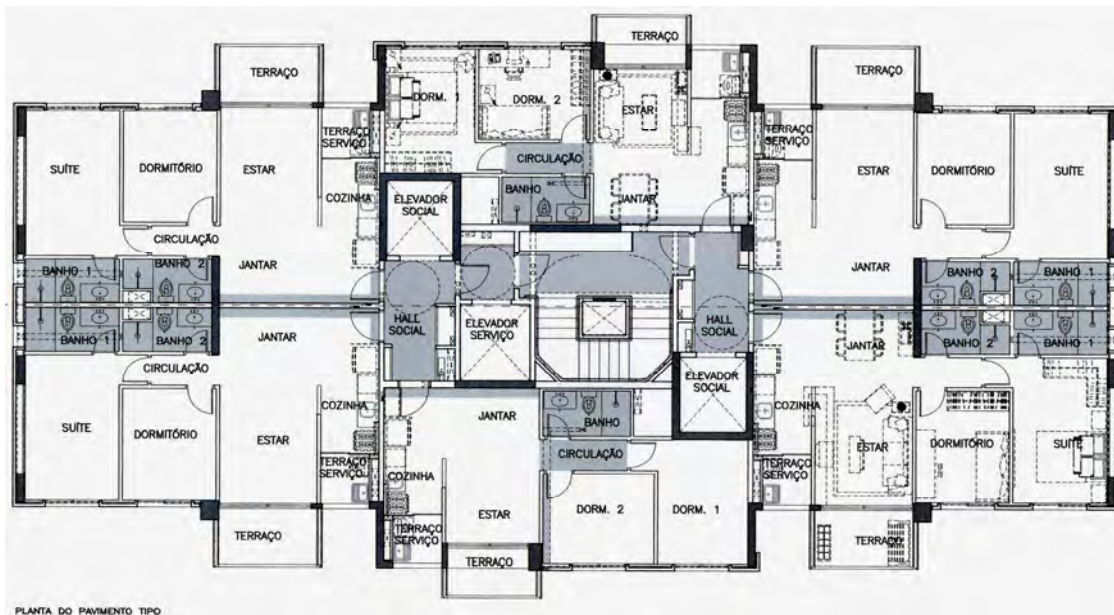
Planta do pavimento tipo (6 unidades/ andar).
